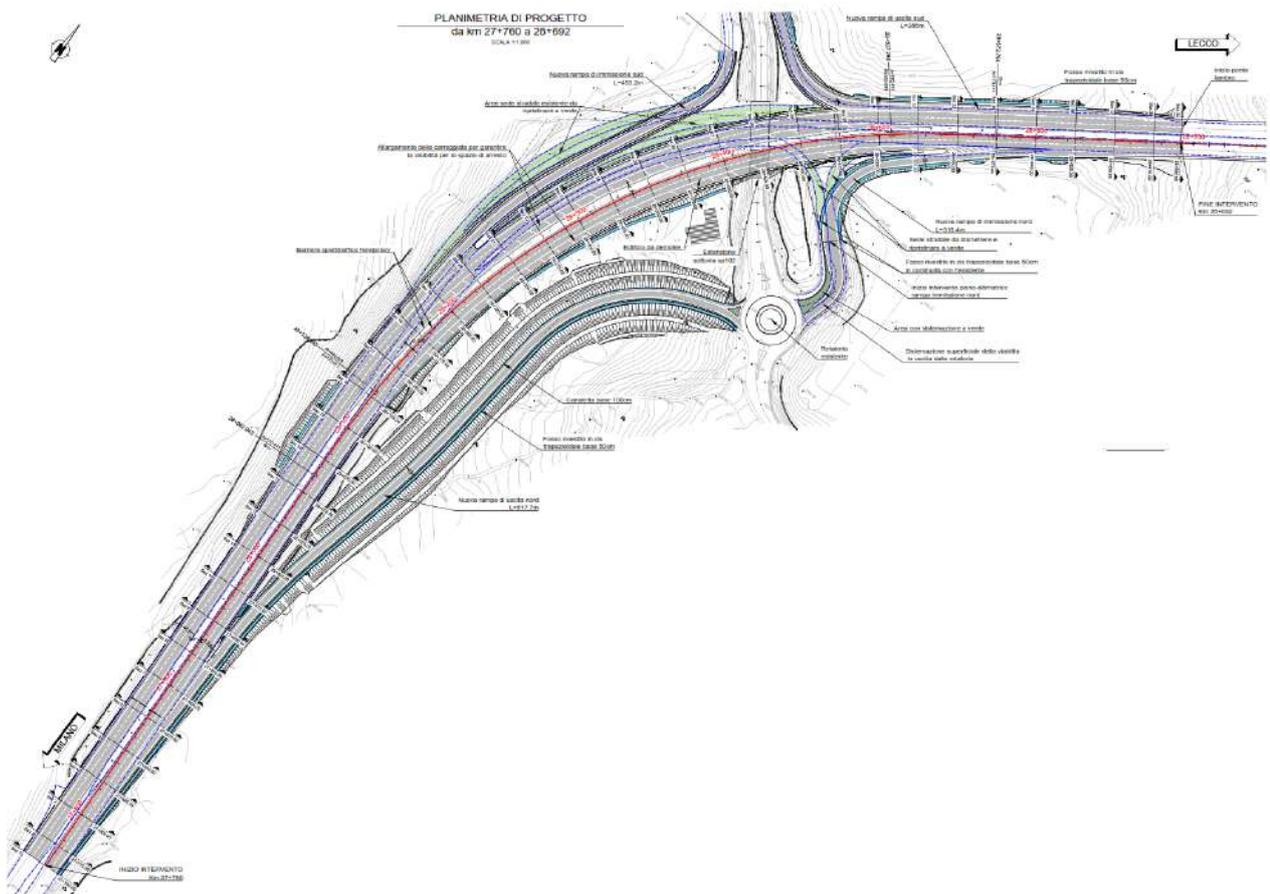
Planimetria di progetto svincolo Briosco - Arosio
